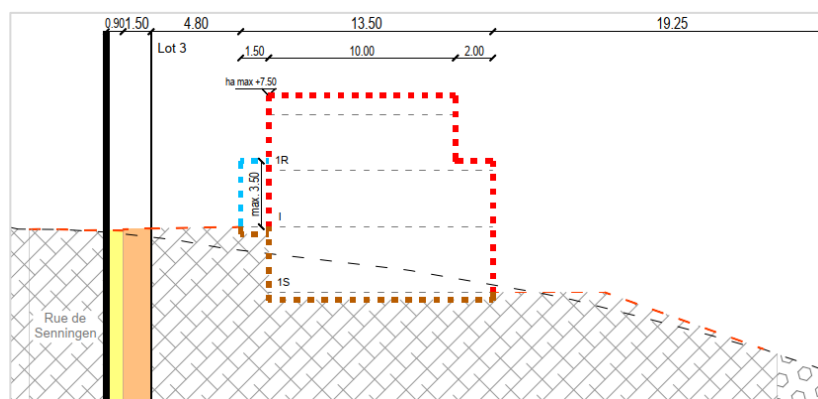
Coupe-Types des constructions futurs (Source : BEST)
